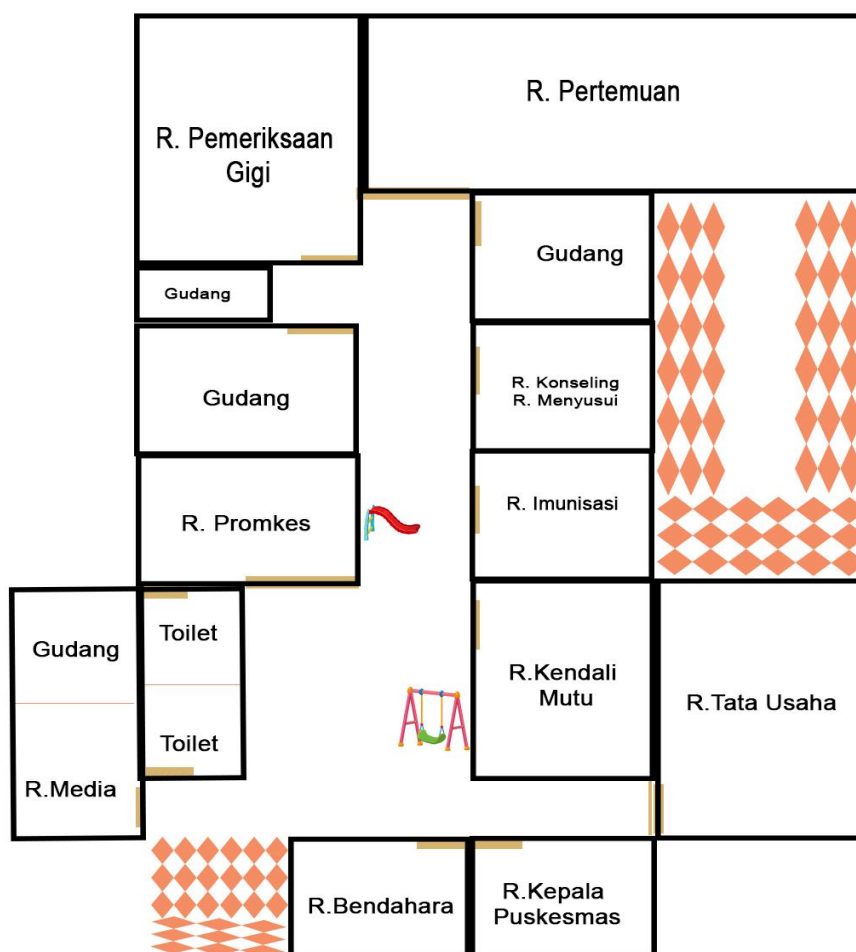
Denah Lantai 1 Puskesmas Trauma Center
